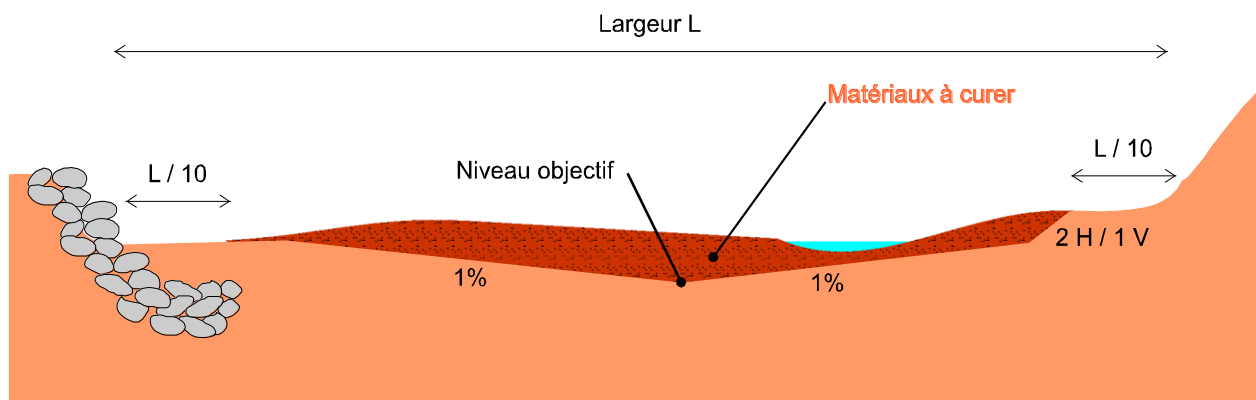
Coupe schématique d'une zone de curage (source ETRM)
